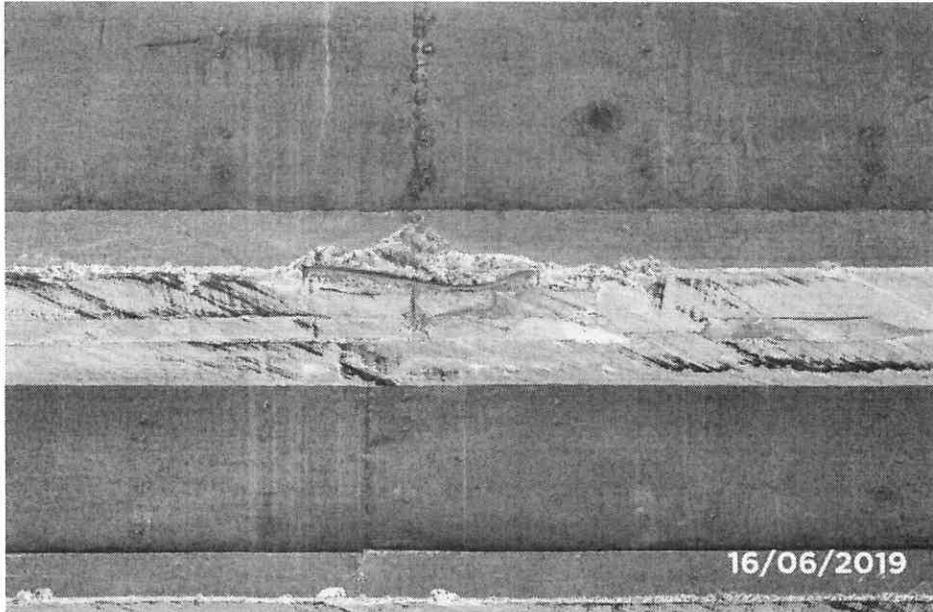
Detalhe das vigas com deslocamento de concreto, e armaduras exposta.
